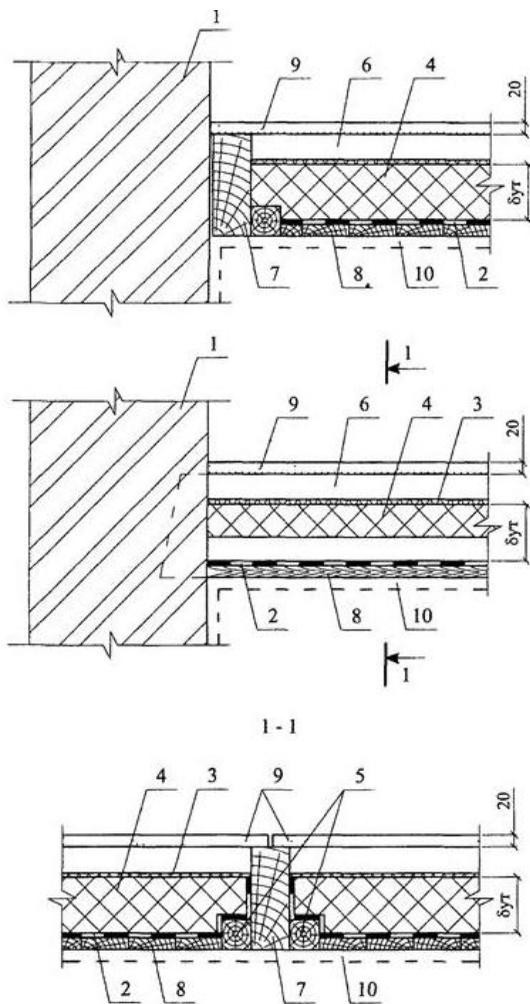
Элементы чердачного перекрытия по деревянным балкам:
